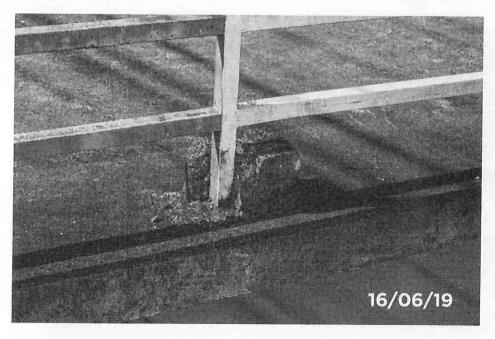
Armadura exposta e corrosão do ponto de fixação do G.C.
